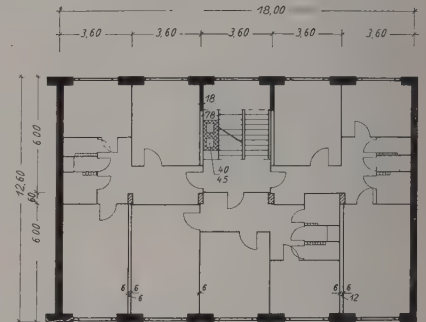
Grundriß eines Wohnhaustyps für die Ziegelblockbauweise mit Innenskelett aus der ČSR
